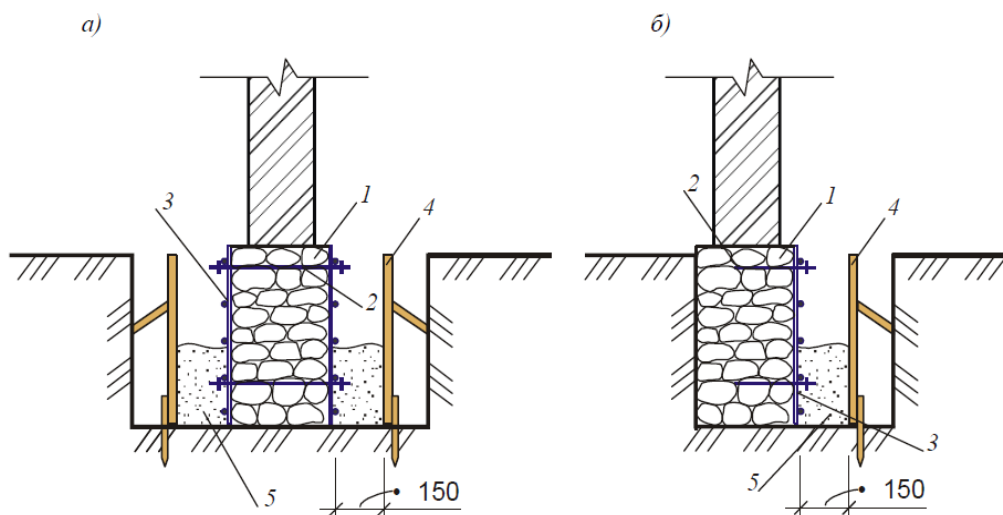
Усиление бутовых фундаментов путем устройства железобетонной обоймы: а – двухсторонней; б – односторонней; 1 – бутовый фундамент; 2 – анкер; 3 – арматурная сетка; 4 – опалубка; 5 – бетонная смесь
